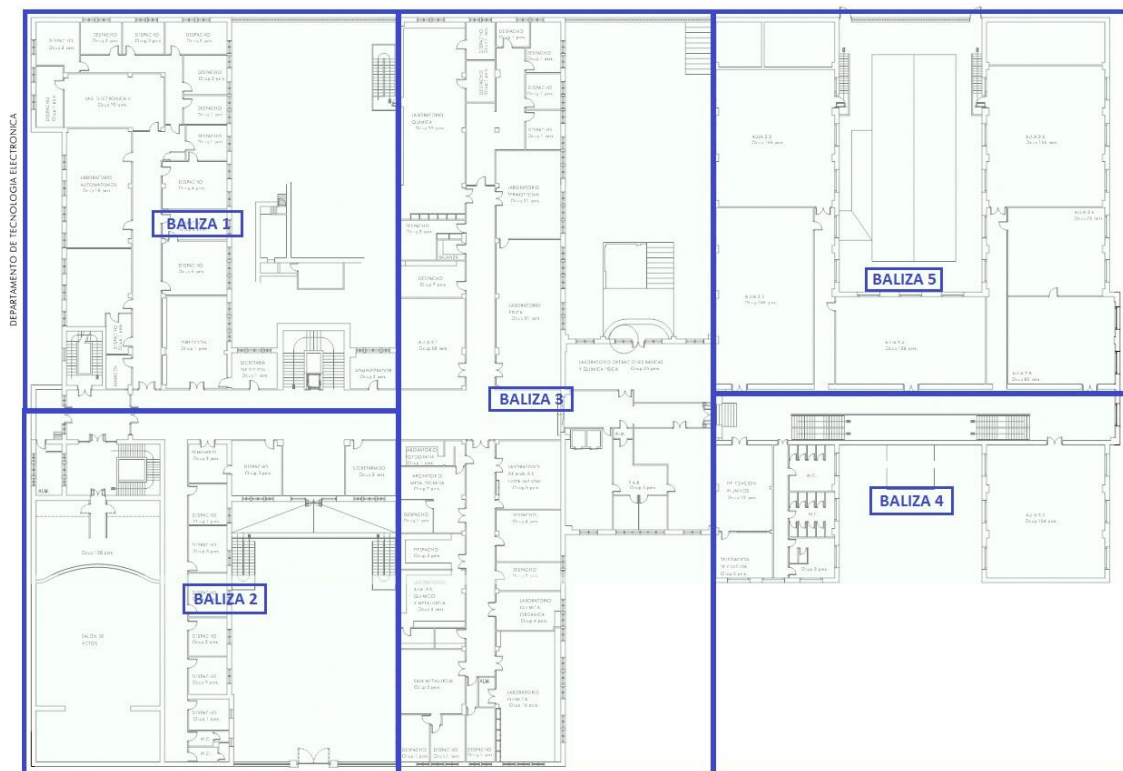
Plano balizas primera planta, sin sectorizado entre plantas
